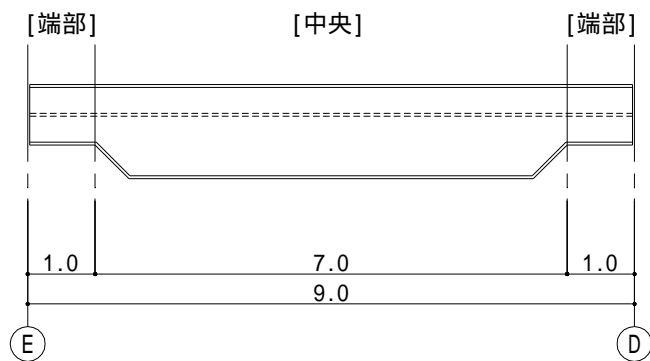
2 ランウェイガード平面図 (単位 : m)
